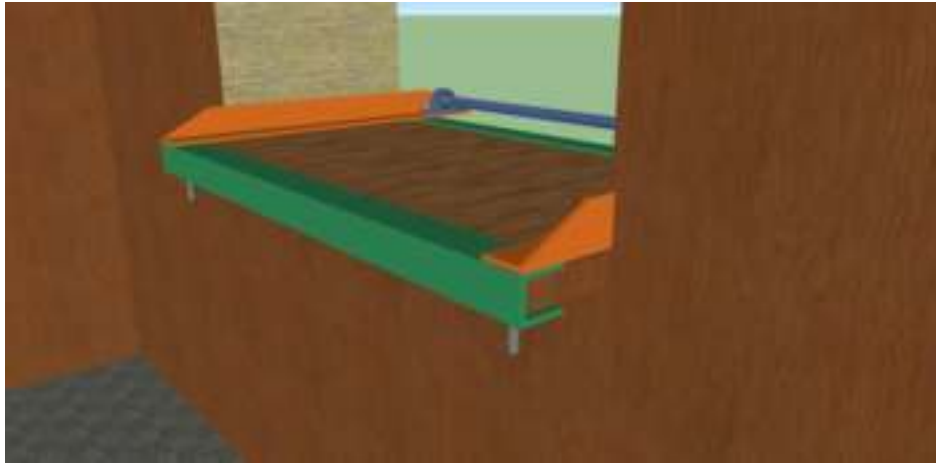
Расположение устройства (конструкции) – вид изнутри
